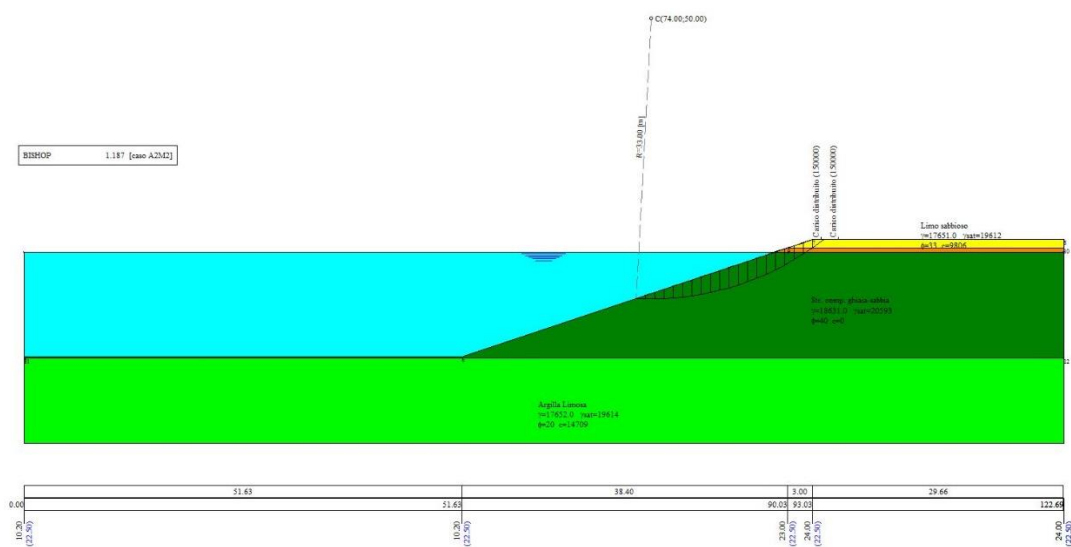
MODELLO DI CALCOLO STABILITÀ SPONDE DI SISTEMAZIONE
